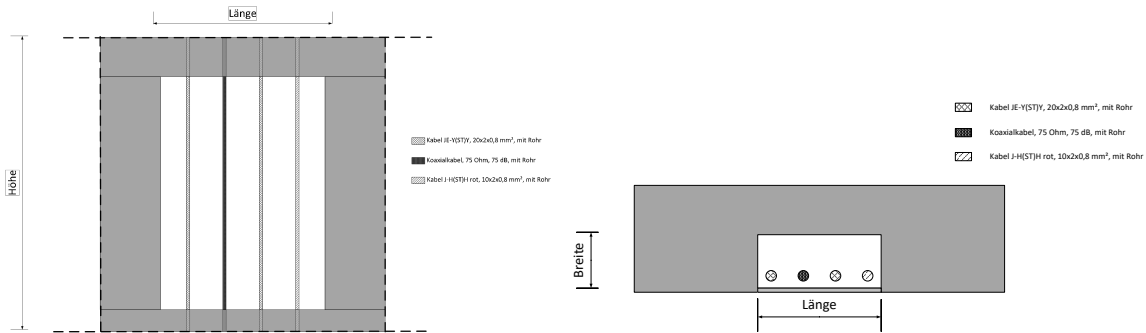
Vertikaler und Horizontaler Schnitt - Elektroinstallationen in Schlitzbauweise⁴⁸⁸
